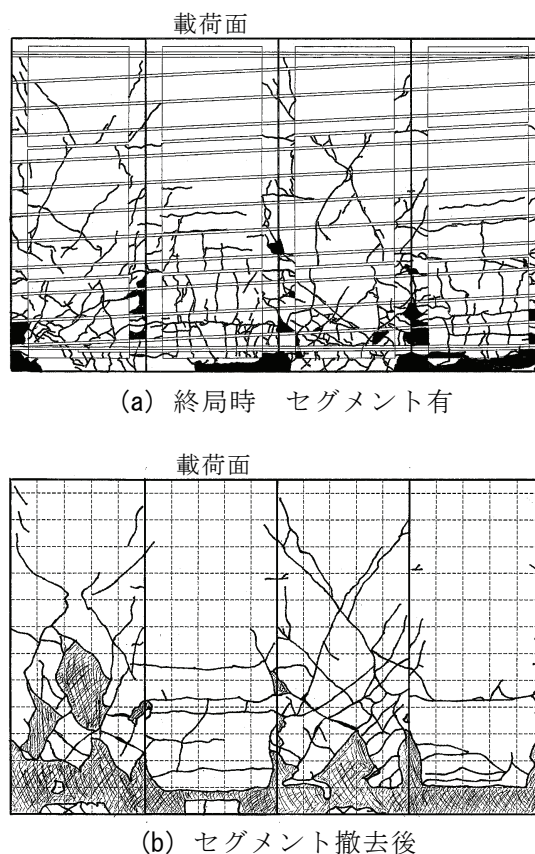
試験体のひび割れ発生状況 (展開図)
